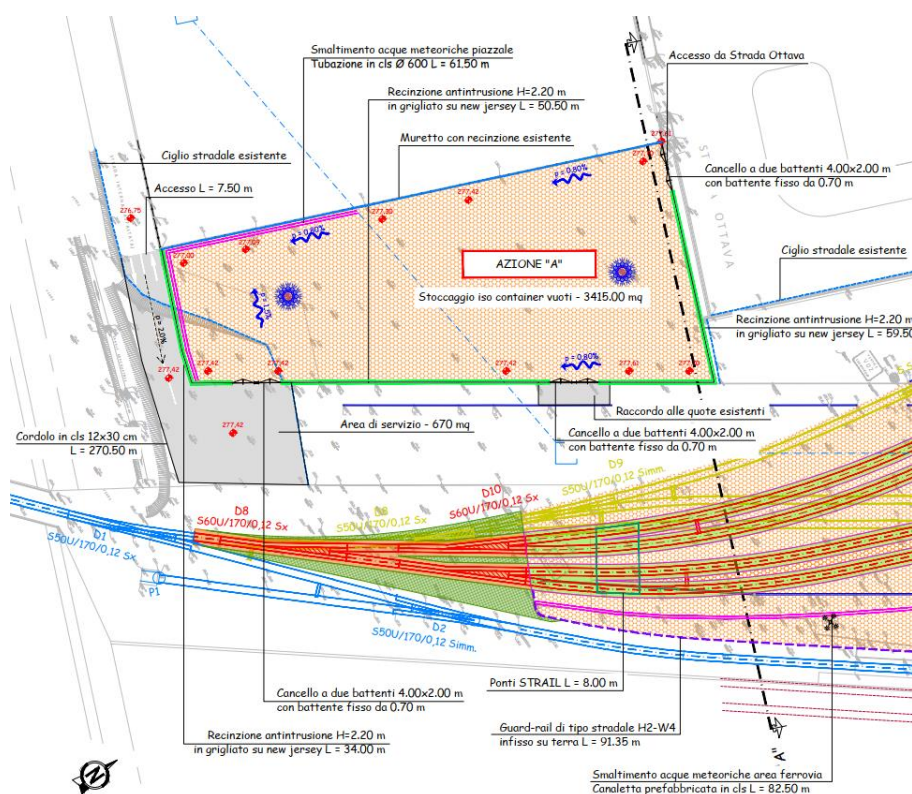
Azione A – Planimetria di progetto piazzale di stoccaggio ISO container
